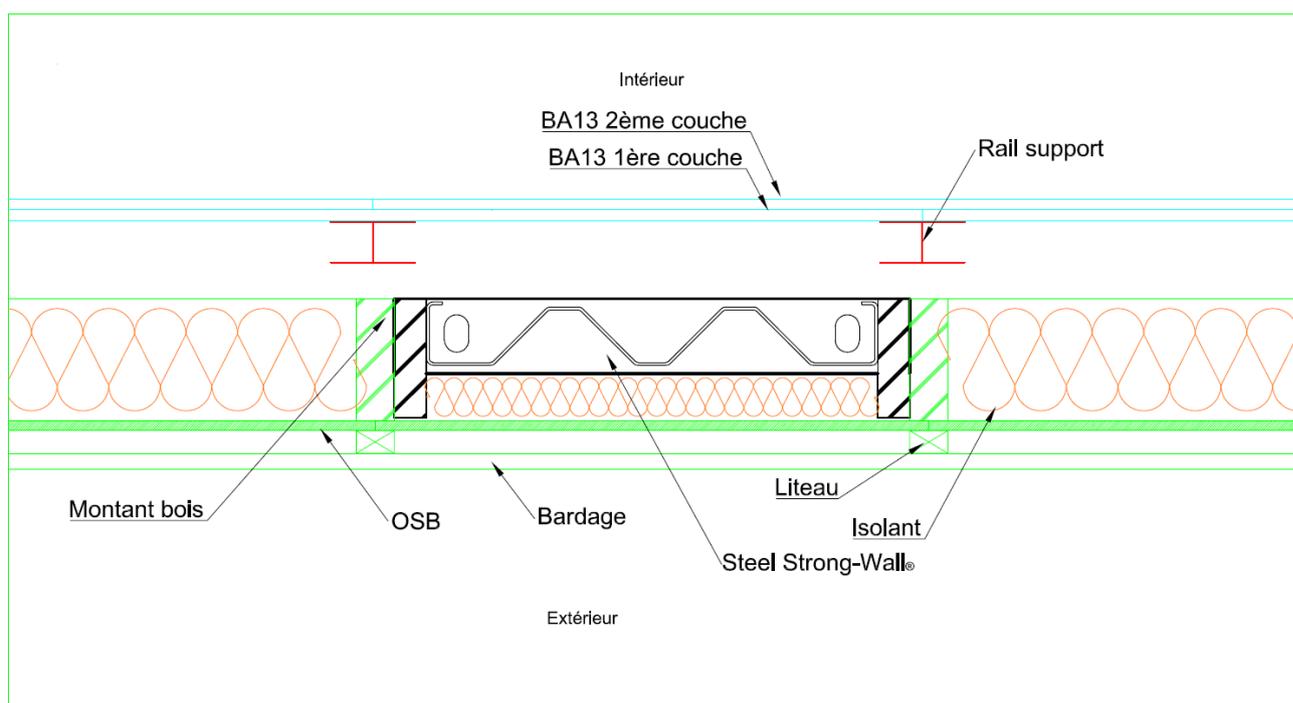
Coupe horizontale - Configuration 2 x plaques 13 mm
